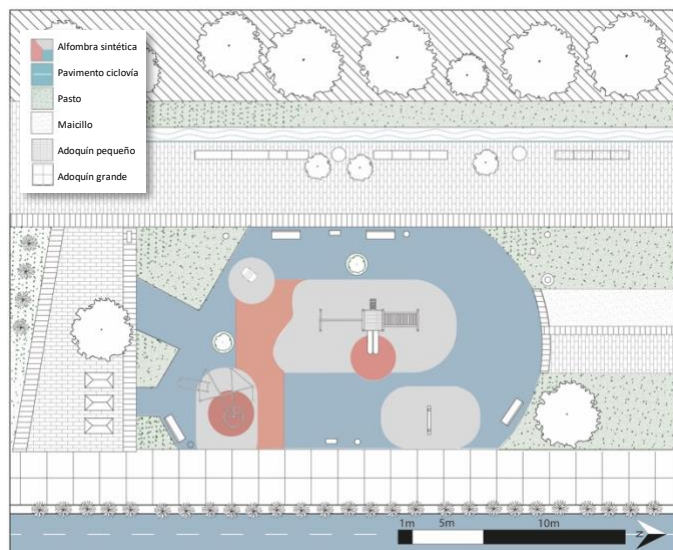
Plano tipos de suelo plaza "B". Fuente: Elaboración propia
